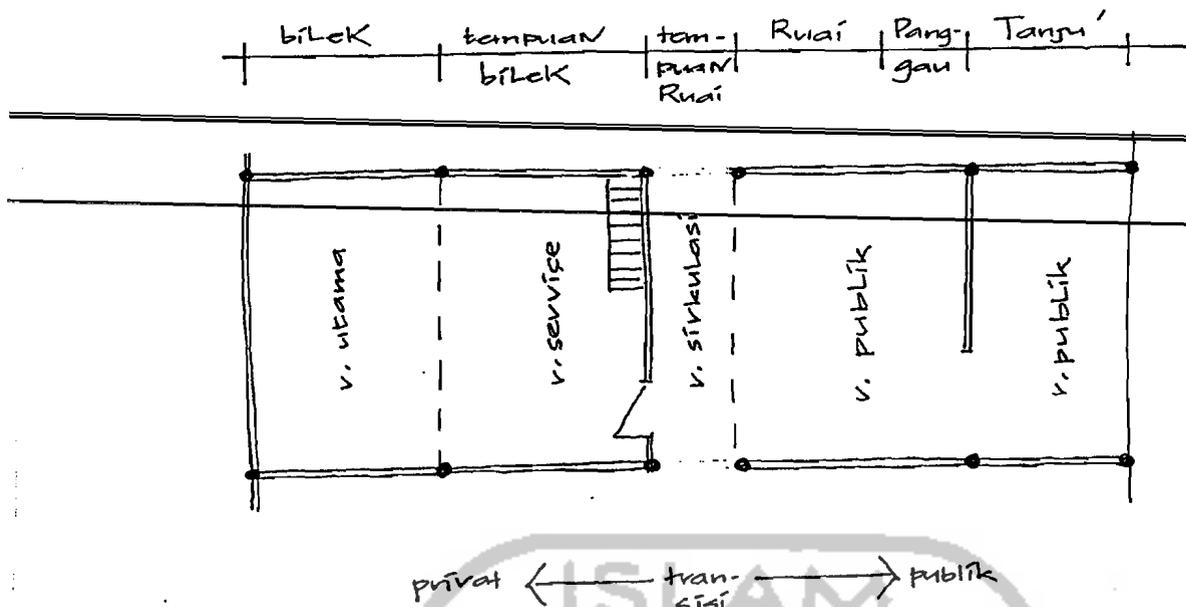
Alternatif Penerapan Tata Ruang Dalam pada TPKL
